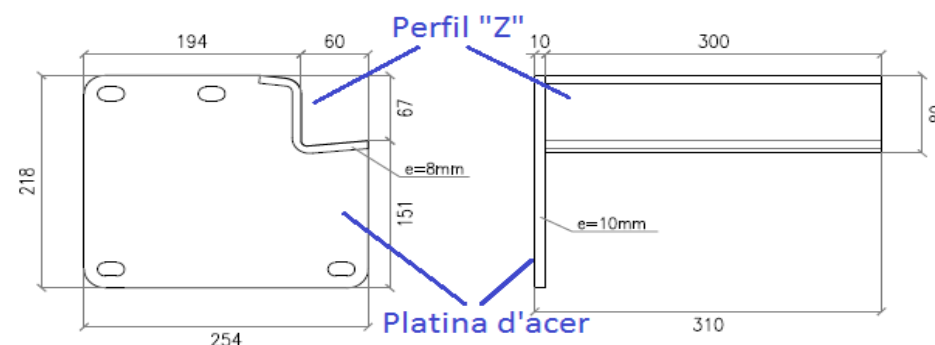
Secció i perfil reforç cap de biga
